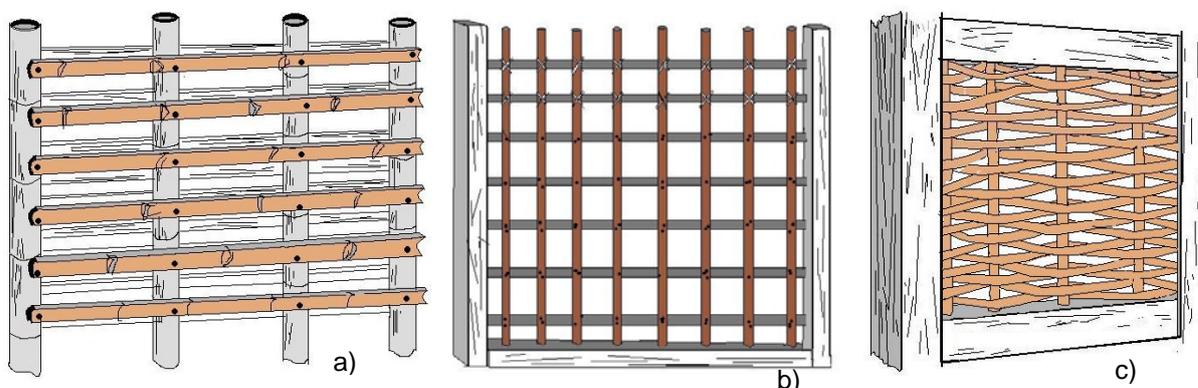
Exemplos de estrutura auxiliar: a) entramado em bambu em trama dupla, uma em cada face da estrutura; b) entramado reticular simples no meio da estrutura; c) tecida em tramas estreitas no meio da estrutura.
